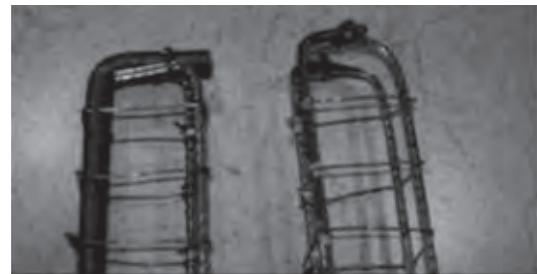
Detalle del refuerzo longitudinal y de los estribos
